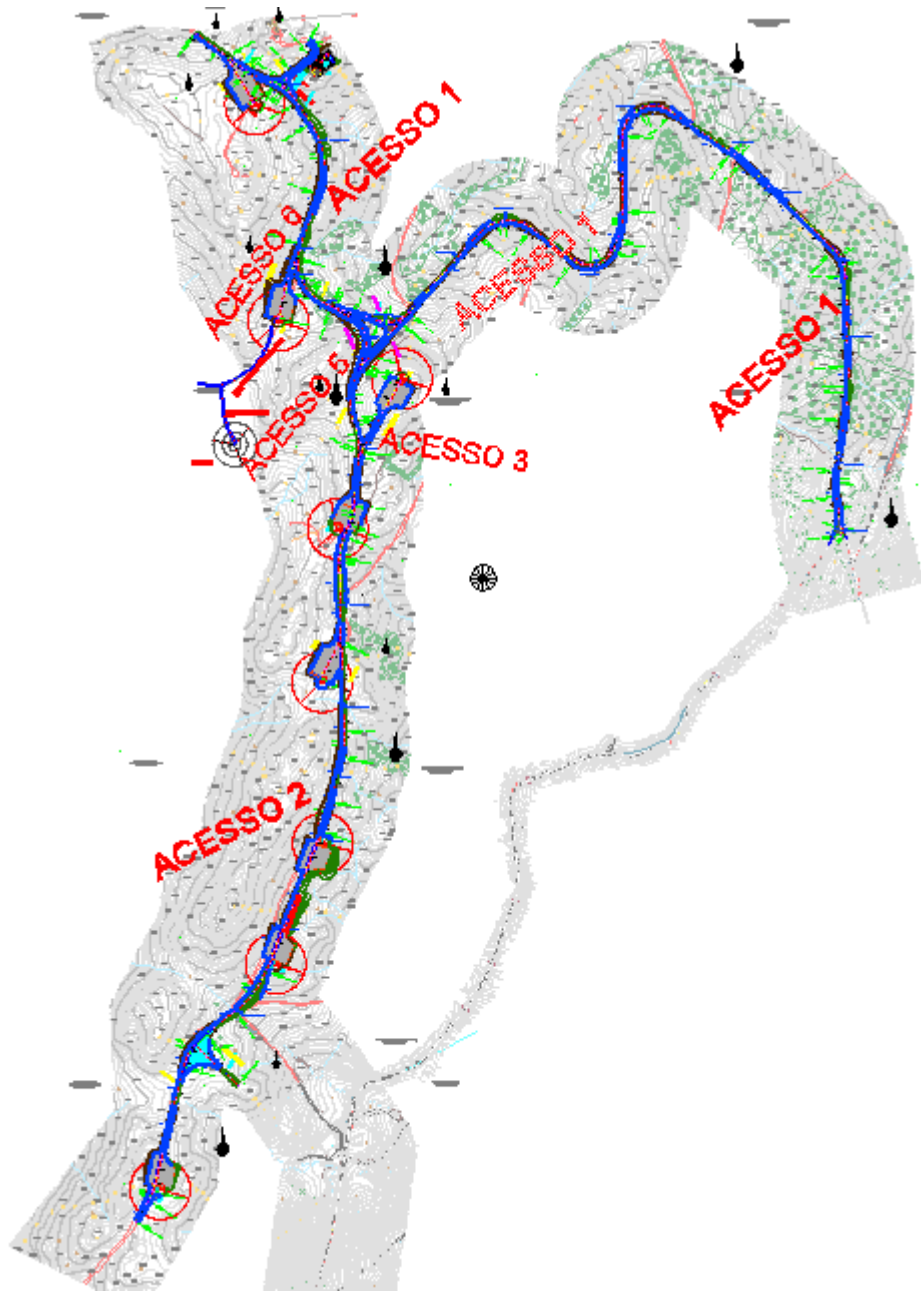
PLANTA DE ACESSOS - NÚCLEO DO PISCO (FONTE: PROJECTO DE EXECUÇÃO)
